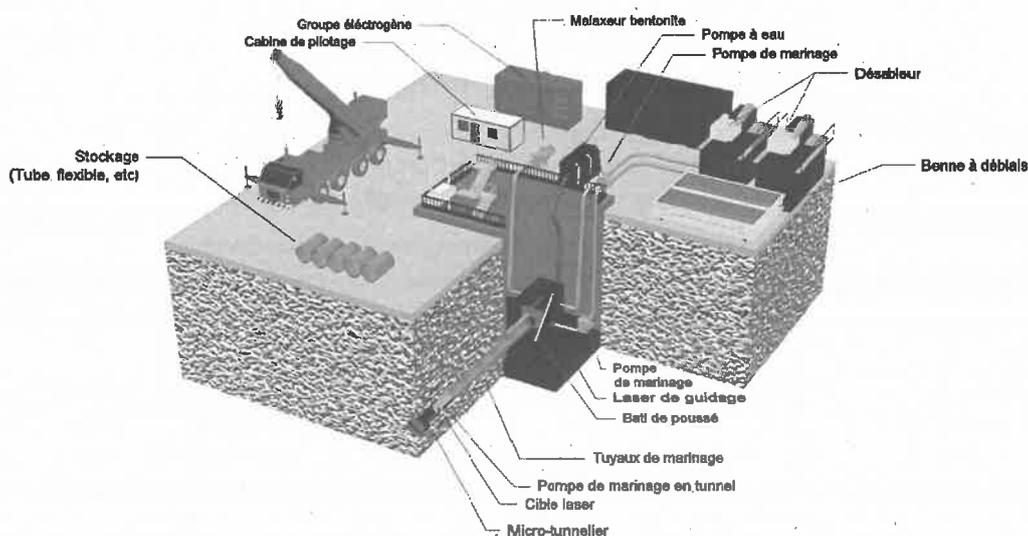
Principe d'un forage au microtunnelier et emprise chantier en surface nécessaire
